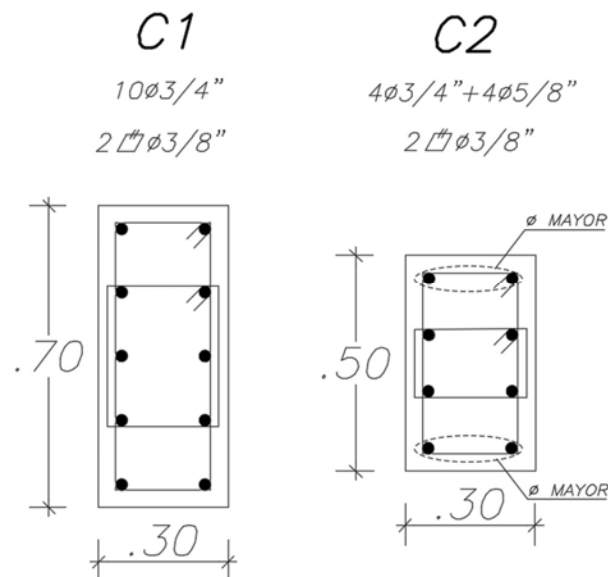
Secciones y acero longitudinal inicial de columnas a diseñar
